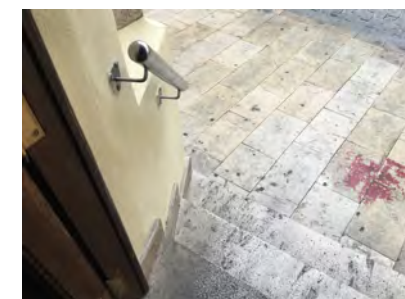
Vista del pasamanos de la escalera de acceso
